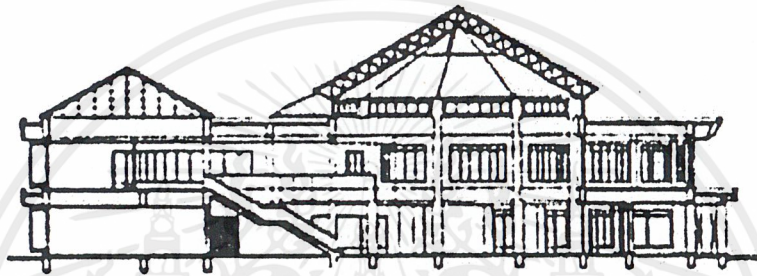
รูปด้านอาคารมองไปทางทิศตะวันตก (West Elevation)
